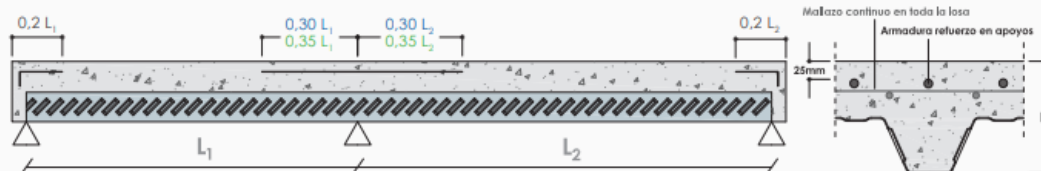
Tabla de utilización armado [Ficha técnica TZ-60F]
